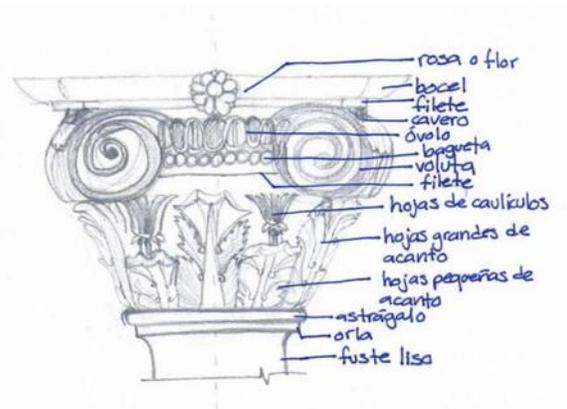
Capitel Compuesto de las pilastras gigantes en el muro de la fachada – elaborado por el autor
